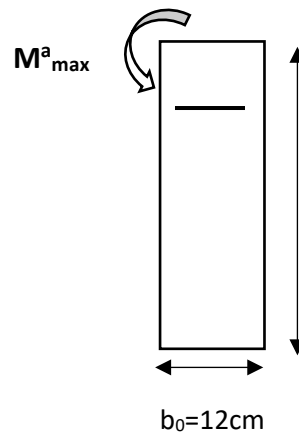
Coupe schématique de la poutrelle (appuis).
